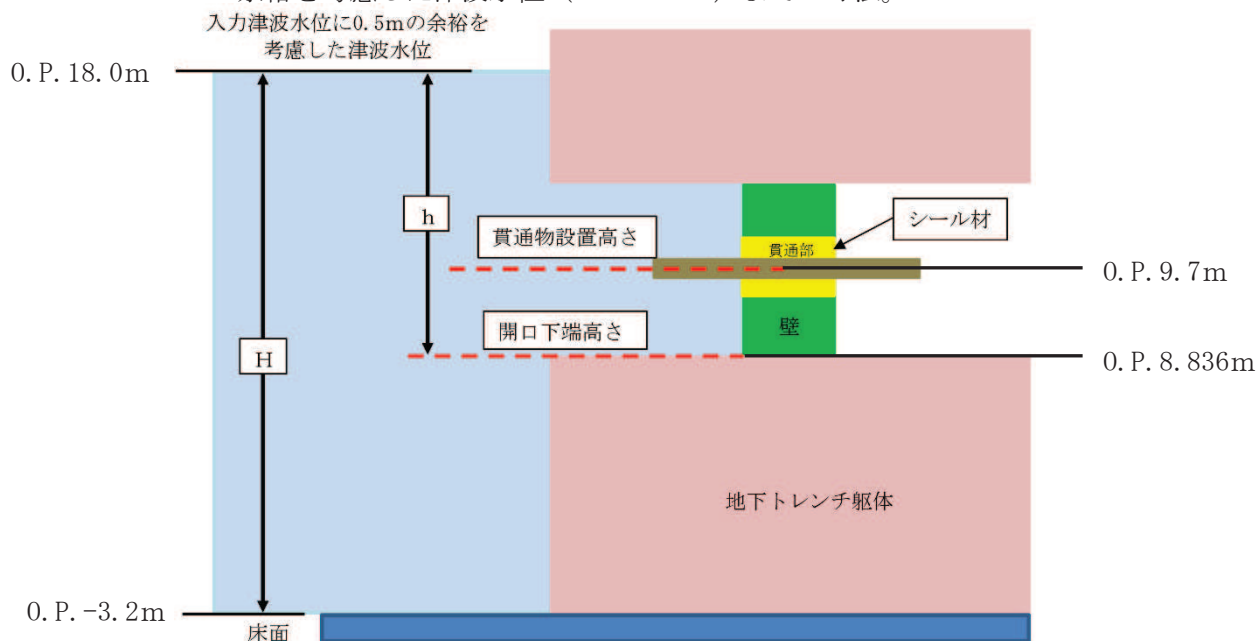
貫通部止水処置（貫通軸：水平）に加わる津波の概要
